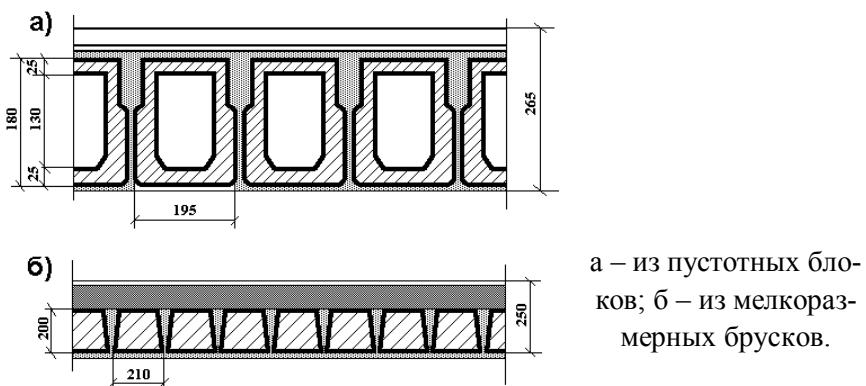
Варианты сборных железобетонных перекрытий из мелкоэлементных конструкций
